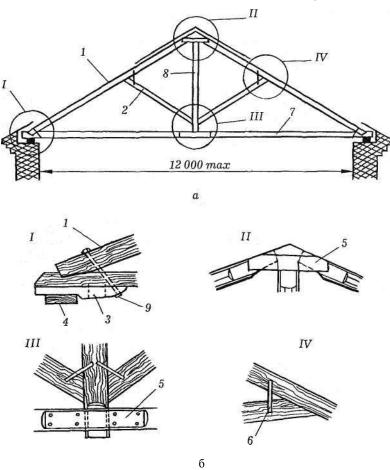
Висячие стропила: а— общий вид конструкции; б— используемые при применении висячих стропил виды креплений: 1— стропильная нога; 2— подкос; 3— подбалка; 4— опорный брус; 5— накладка; 6— крепление скобой; 7— затяжка; 8— бабка; 9— болт
